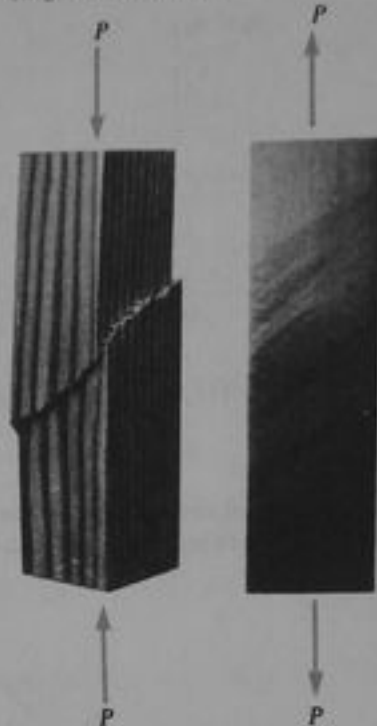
Falla a lo largo de un plano a 45° de un bloque de madera cargado en compresión
